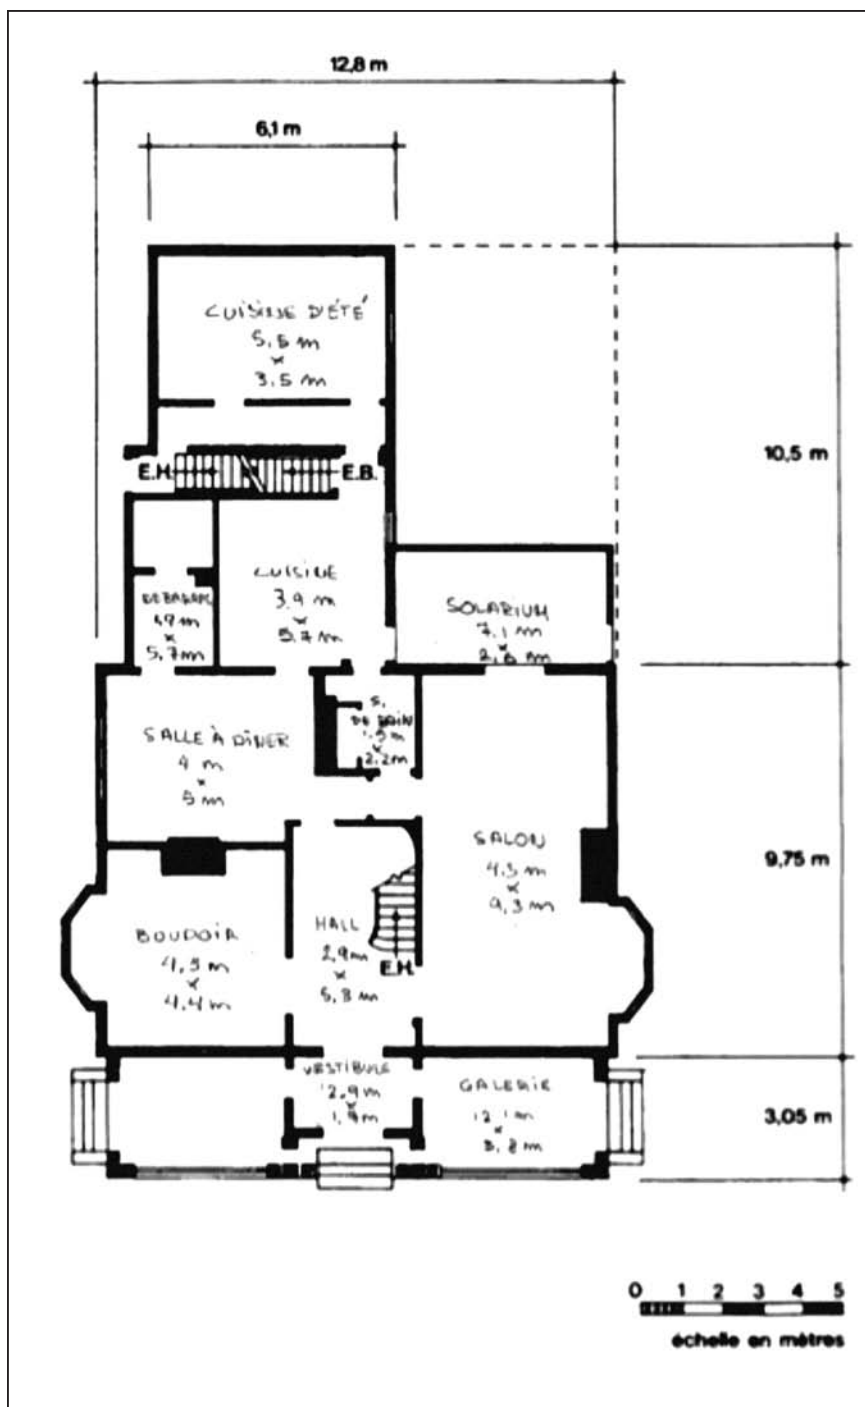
Maison Morey, plan du rez-de-chaussée, SHCE, 1978.
